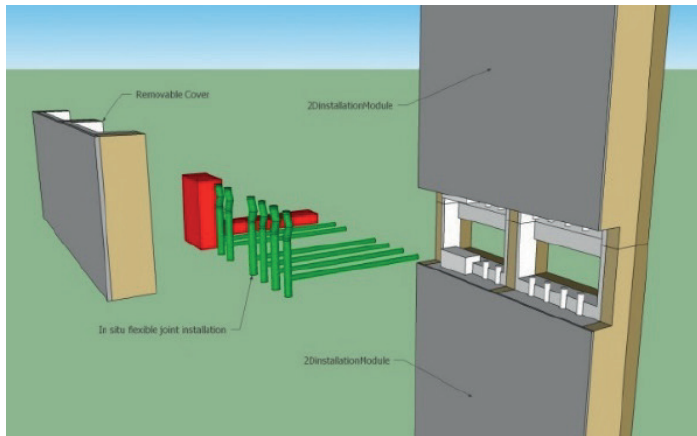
Módulo de instalaciones BERTIM. Las piezas en forma de T acoplan tuberías y conductos de dos módulos y penetran en las viviendas. [Fuente: proyecto BERTIM]
